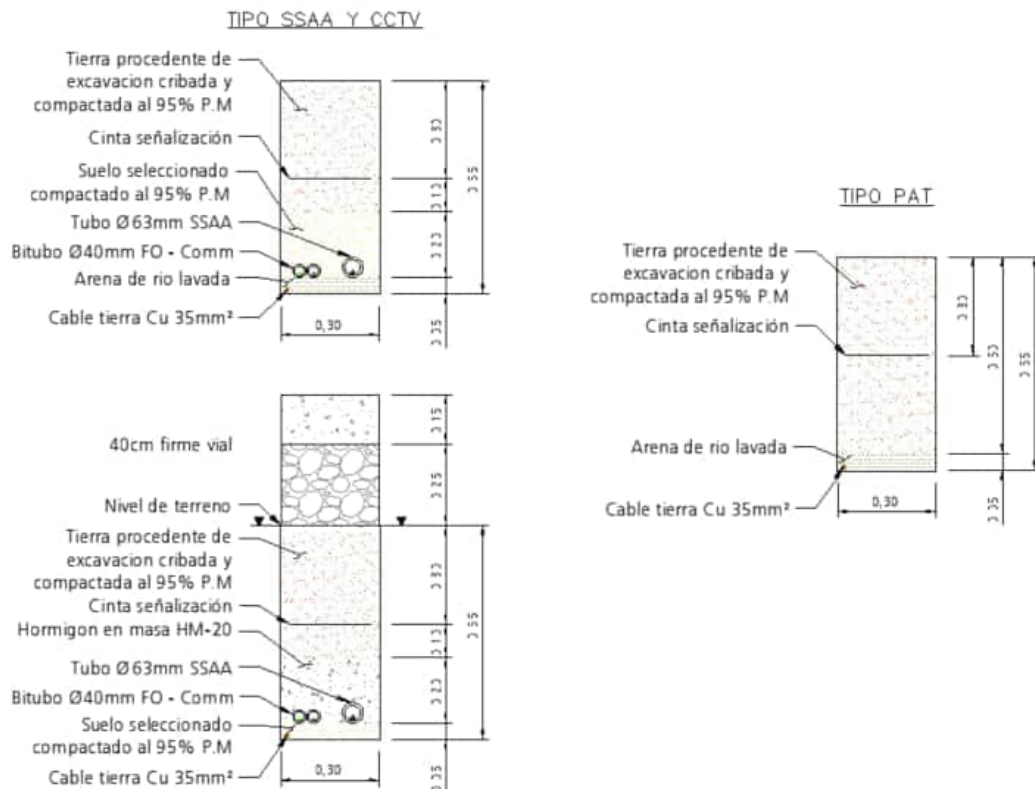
Detalle de zanjas SSAA+COMM y PAT
